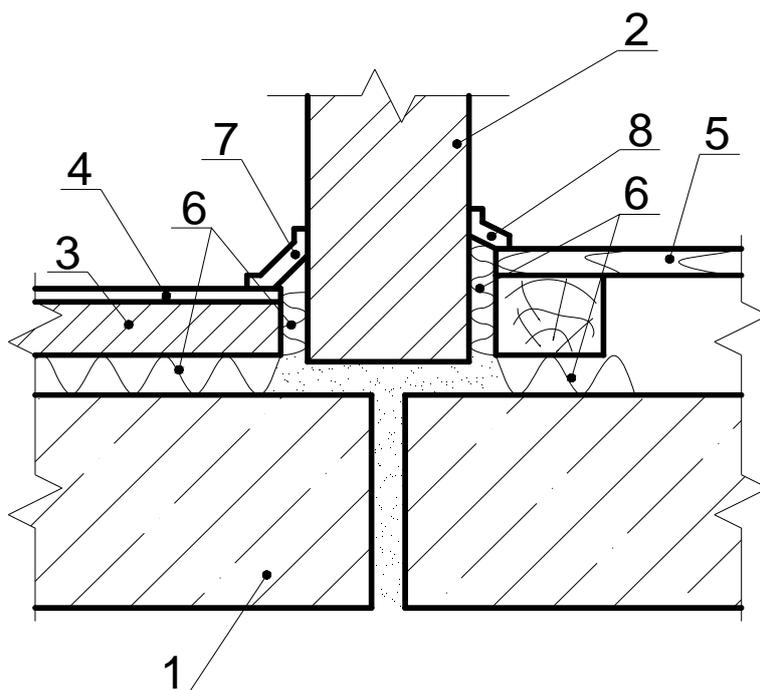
Схема конструктивного решения узла примыкания пола на звукоизоляционном слое к стене (перегородке):
